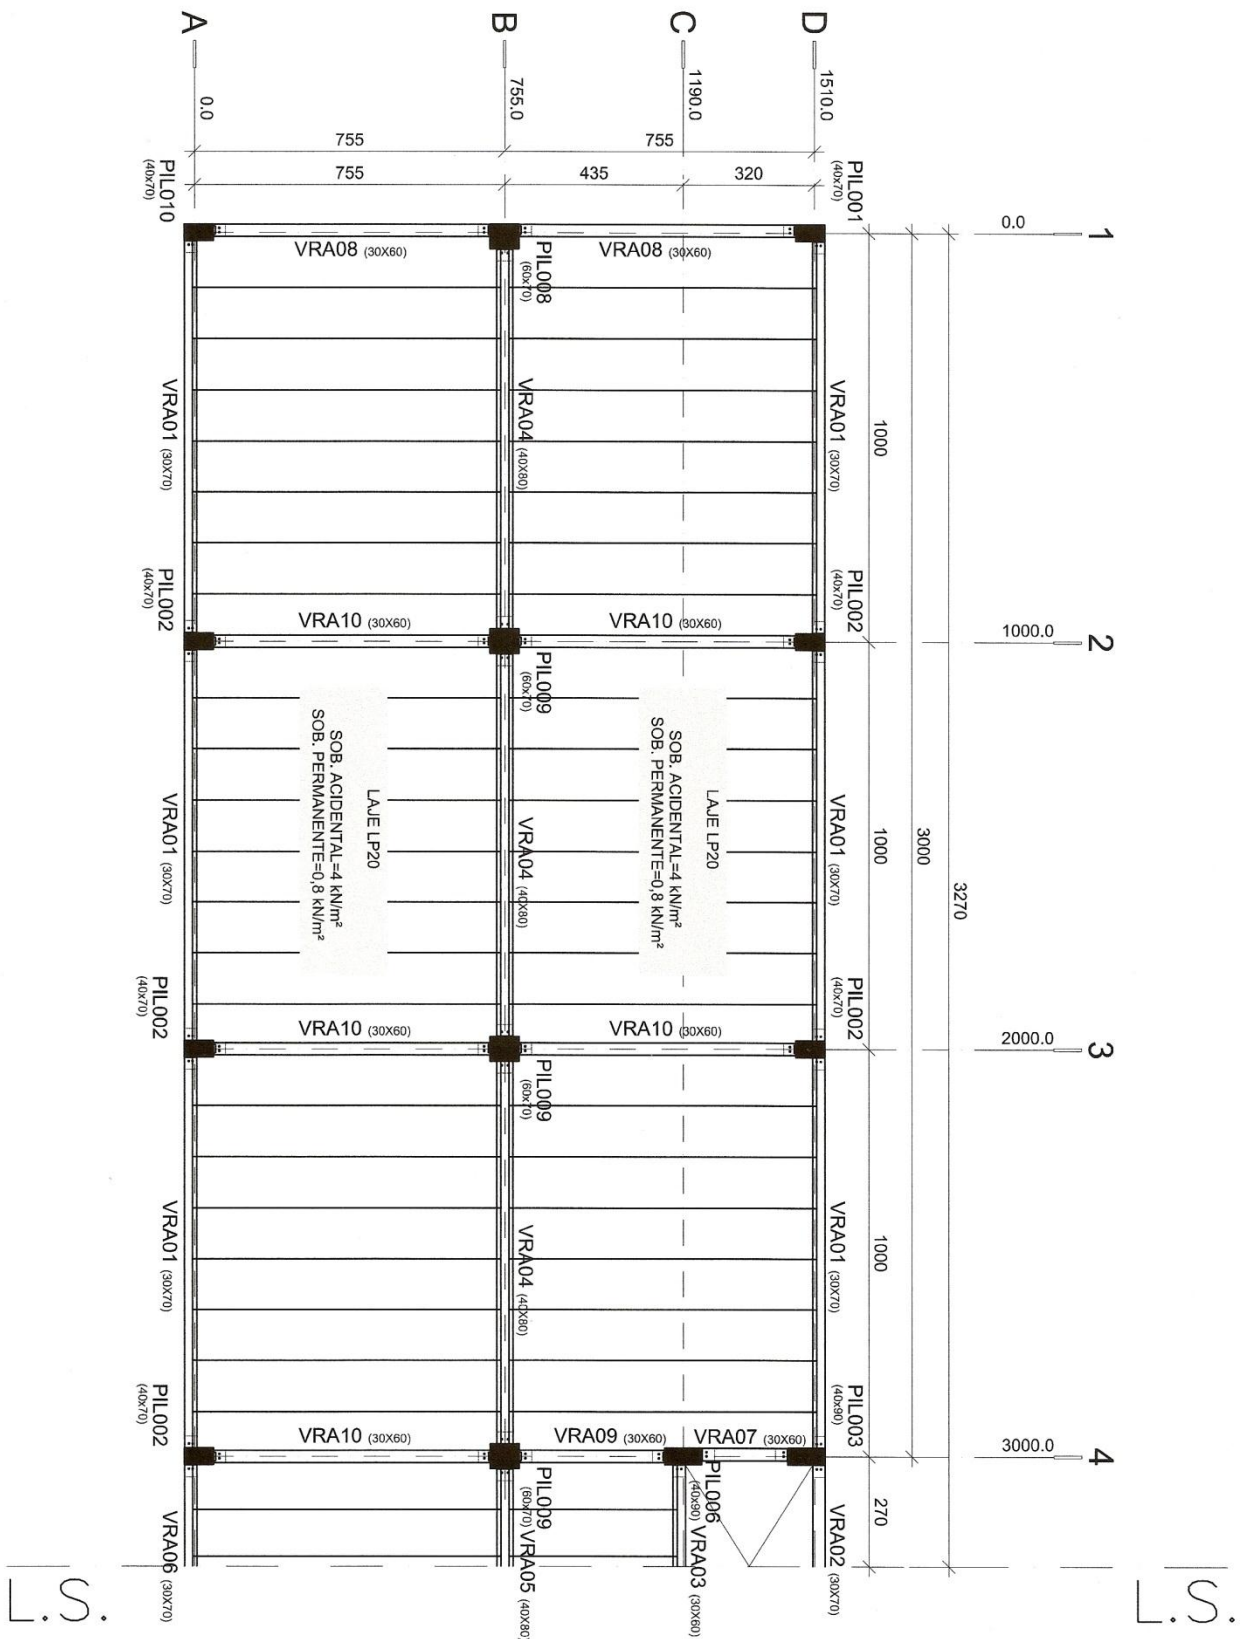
19 – Pavimento tipo da estrutura a ser analisada neste exemplo.
